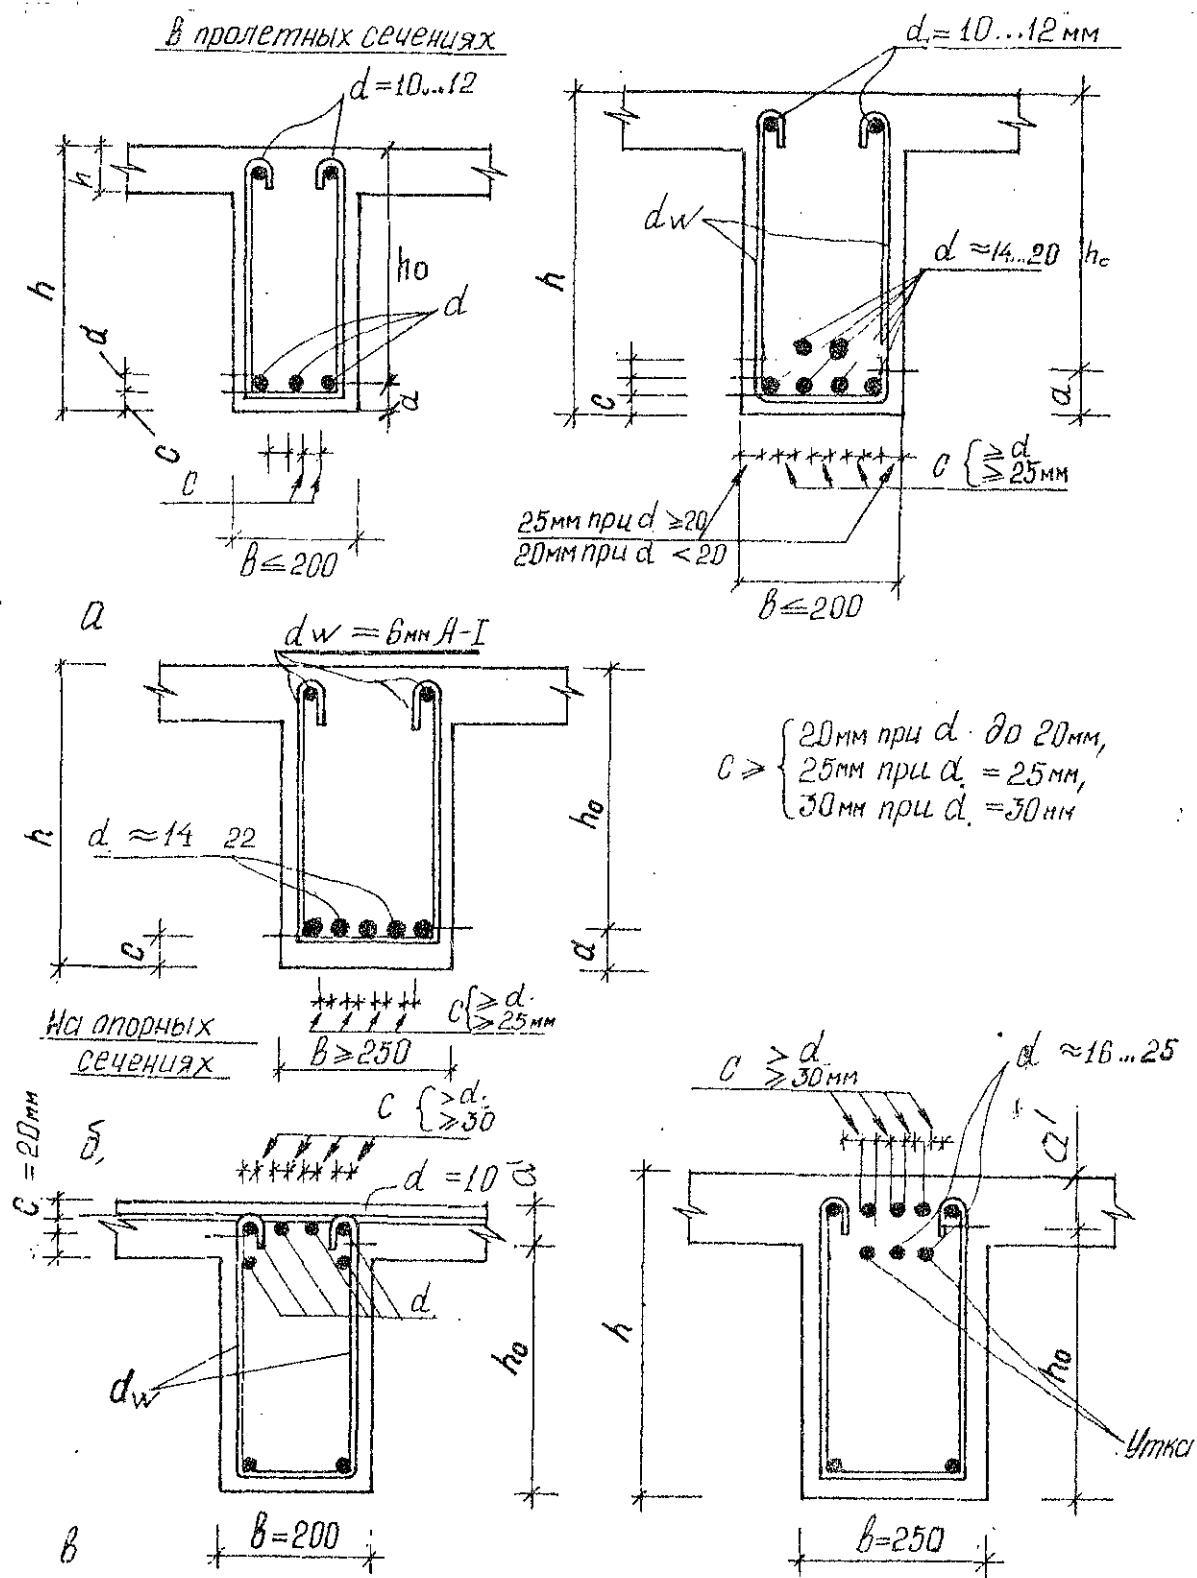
Расположение стержней вязаных каркасов в сечениях второстепенных балок: а - в пролетных сечениях при $b \leq 200$ мм и арматуре в один ряд; б - то же в два ряда; в - при $b \geq 250$ мм и арматуре в один ряд; г - на опорных сечениях при $b = 200$ мм; д - то же при $b = 250$ мм
